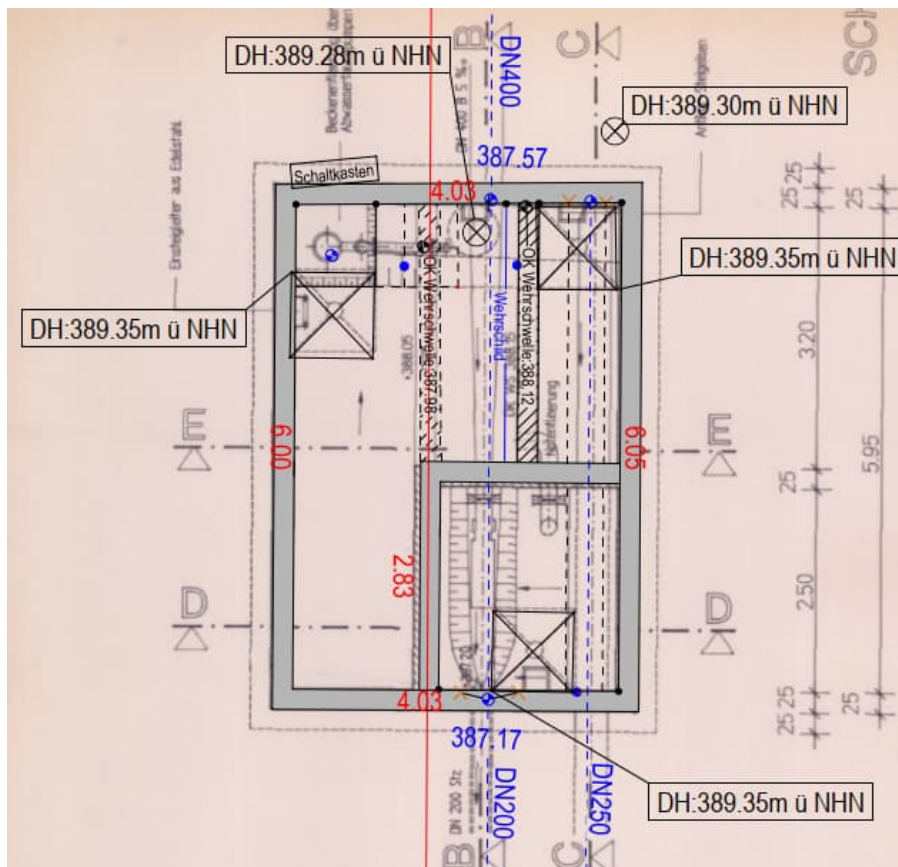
Grundriss RÜB 5 Weidach Neuseser Wegäcker
